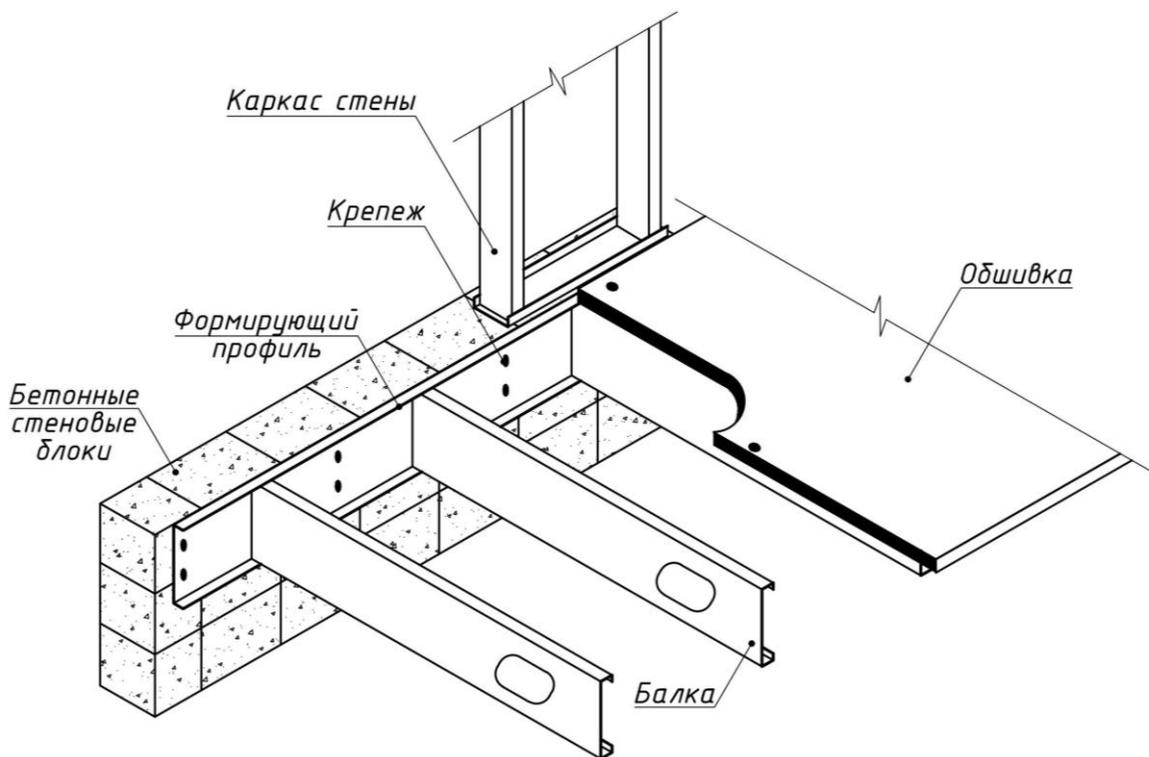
Узел П 11. Крепление перекрытия к бетонным стеновым блокам
